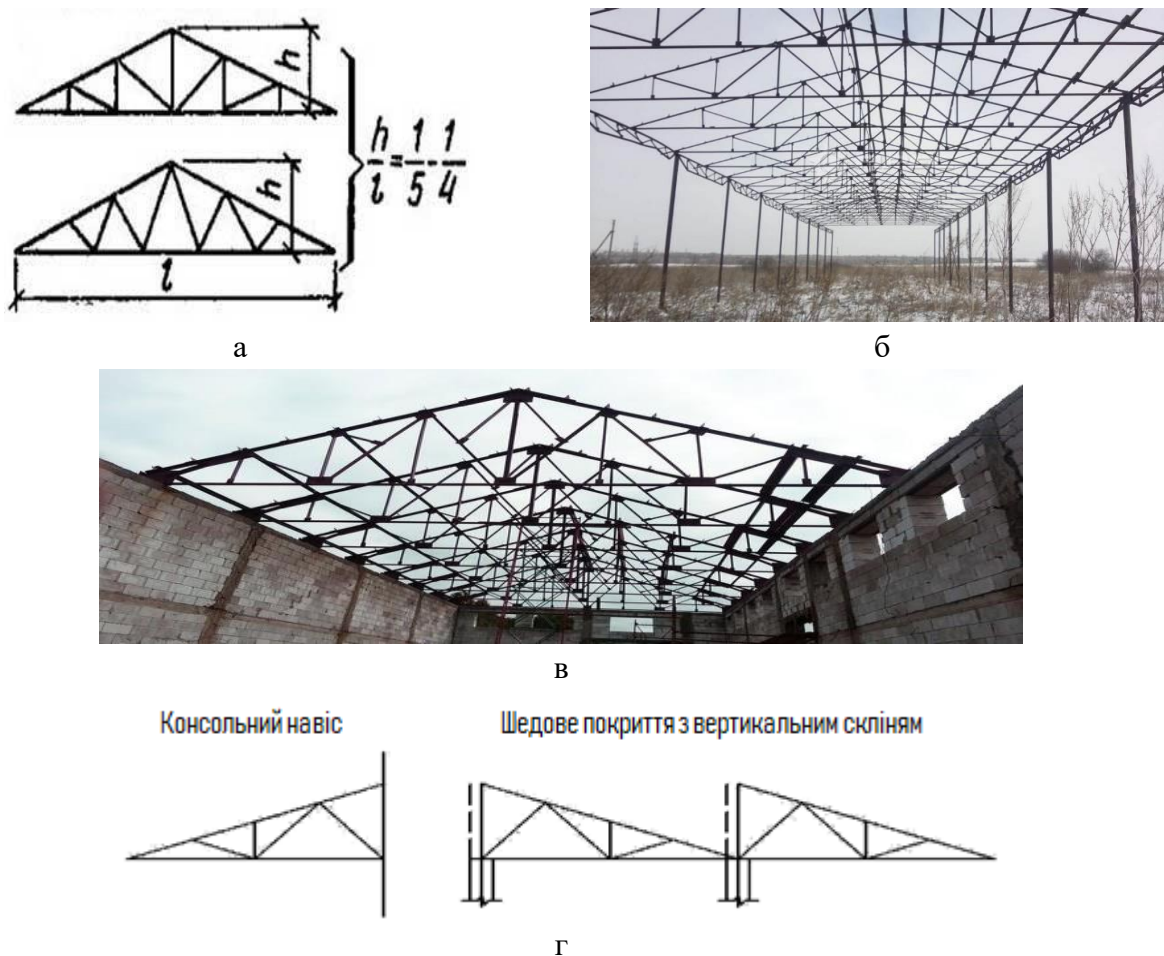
Трикутні кроквяні ферми: а – схеми ферми; б, в – збудовані покриття з трикутними фермами; г – можливі схеми покриттів з трикутними фермами
